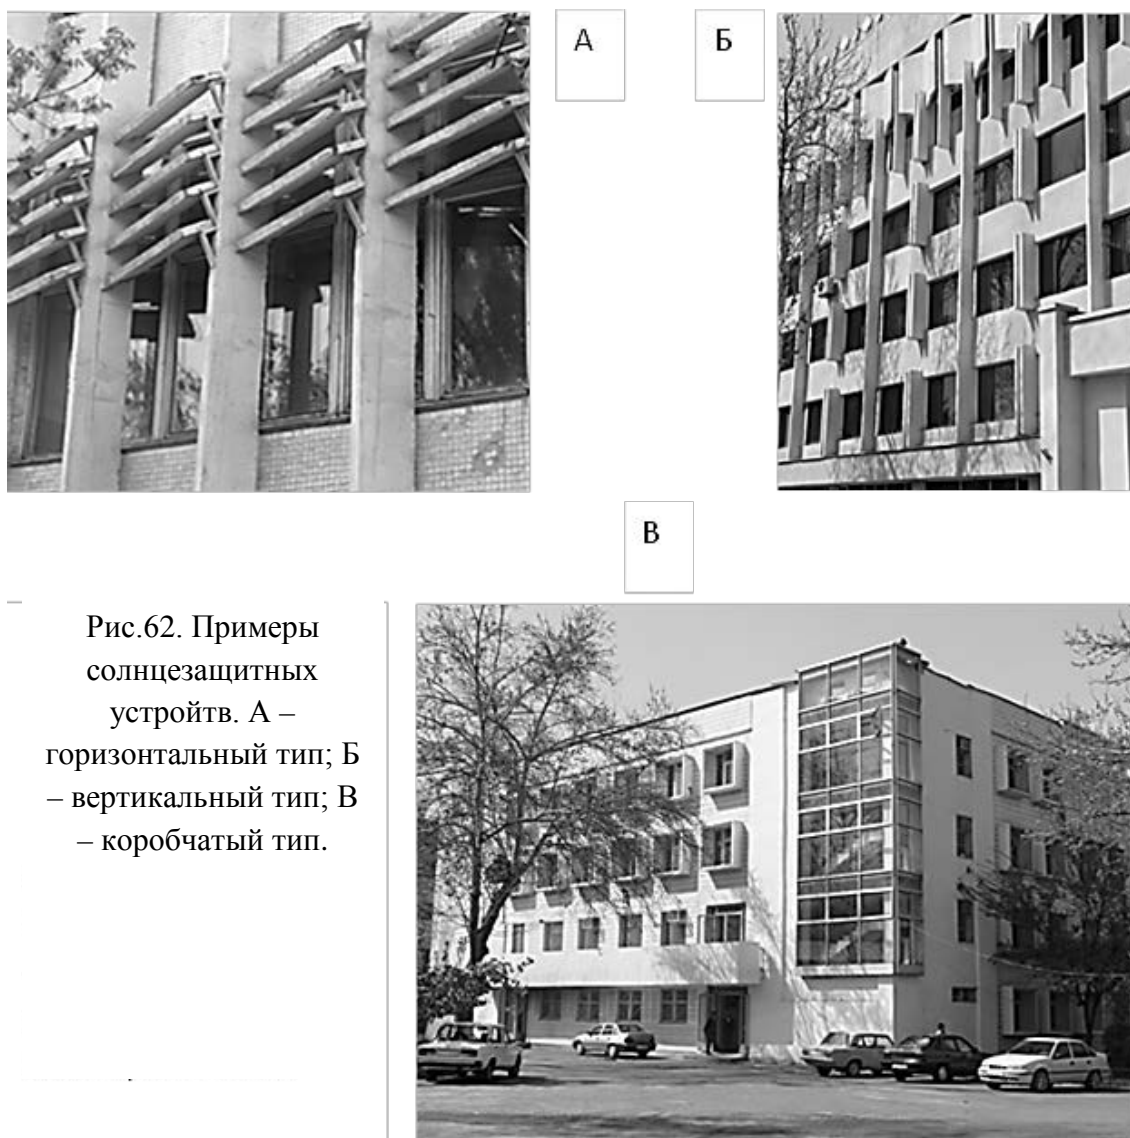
Примеры солнцезащитных устройств. А – горизонтальный тип; Б – вертикальный тип; В – коробчатый тип.
